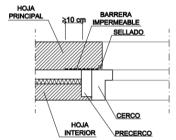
Ejemplo de encuentro de la fachada con la carpintería
